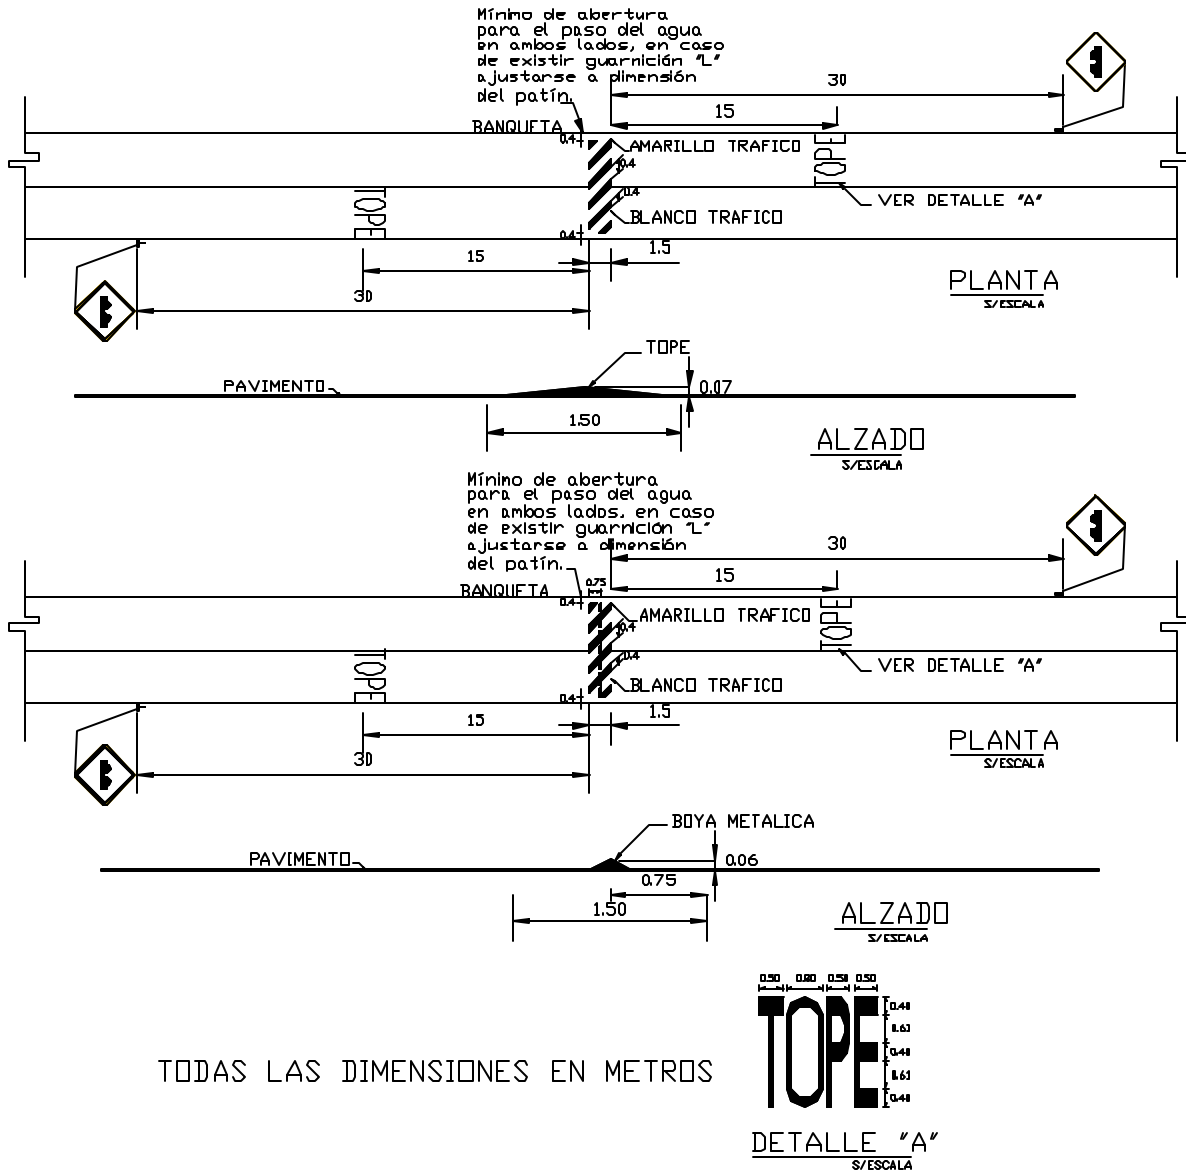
Topes de concreto asfáltico y topes de boyas metálicas, con detalles de señales.
